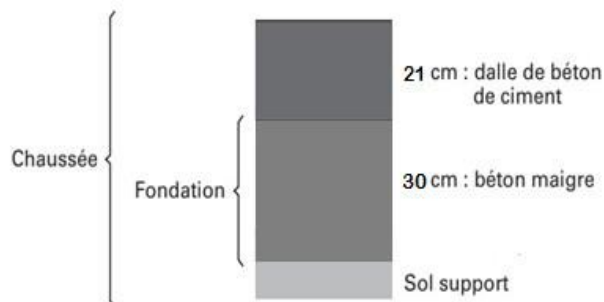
Épaisseur des couches de chaussée rigides pour une zone des Accotement et POR.
